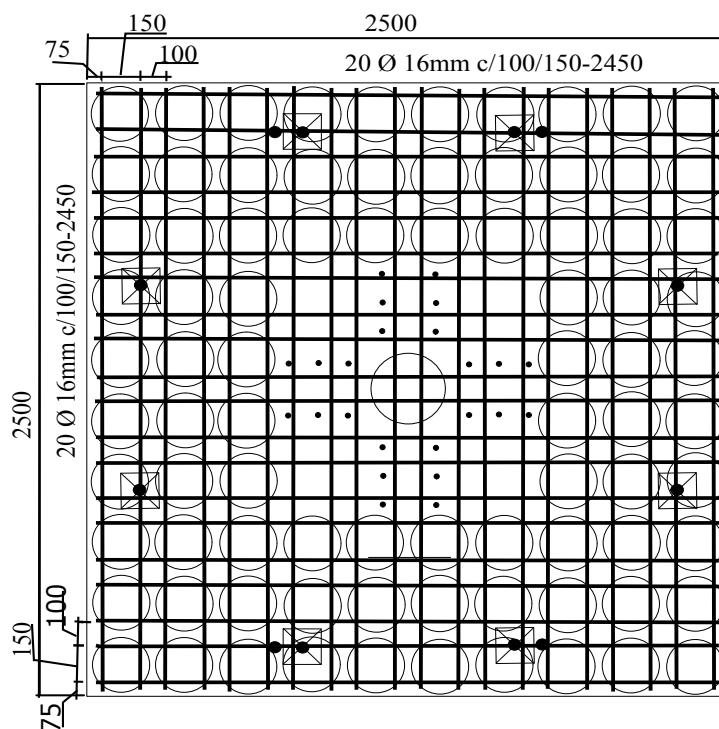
Detalhe da armadura de flexão, medidas em mm
